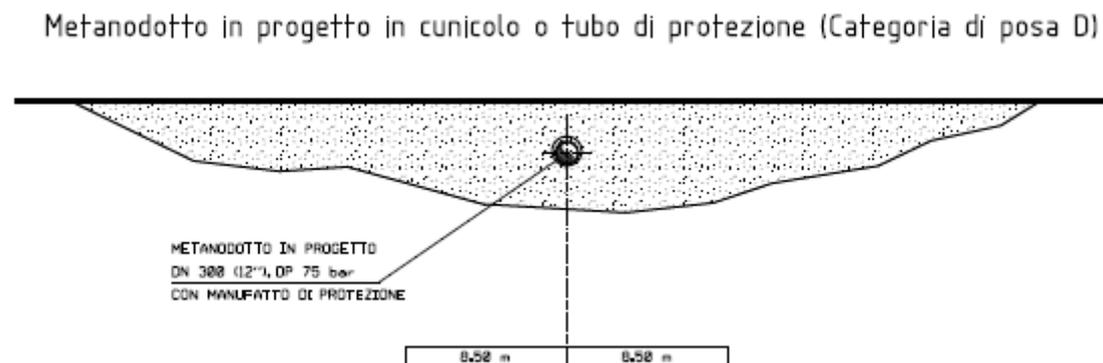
individuazione della fascia di asservimento in condizione di posa D
